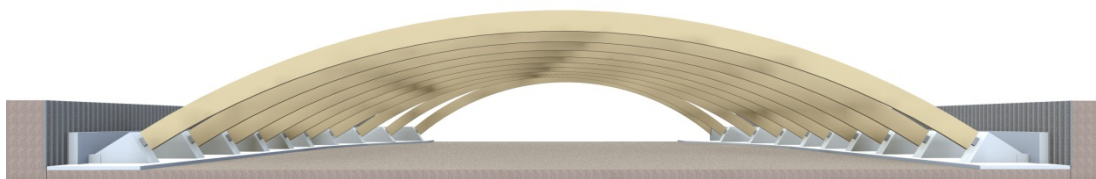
SISTEMA STRUTTURALE AD ARCHI
